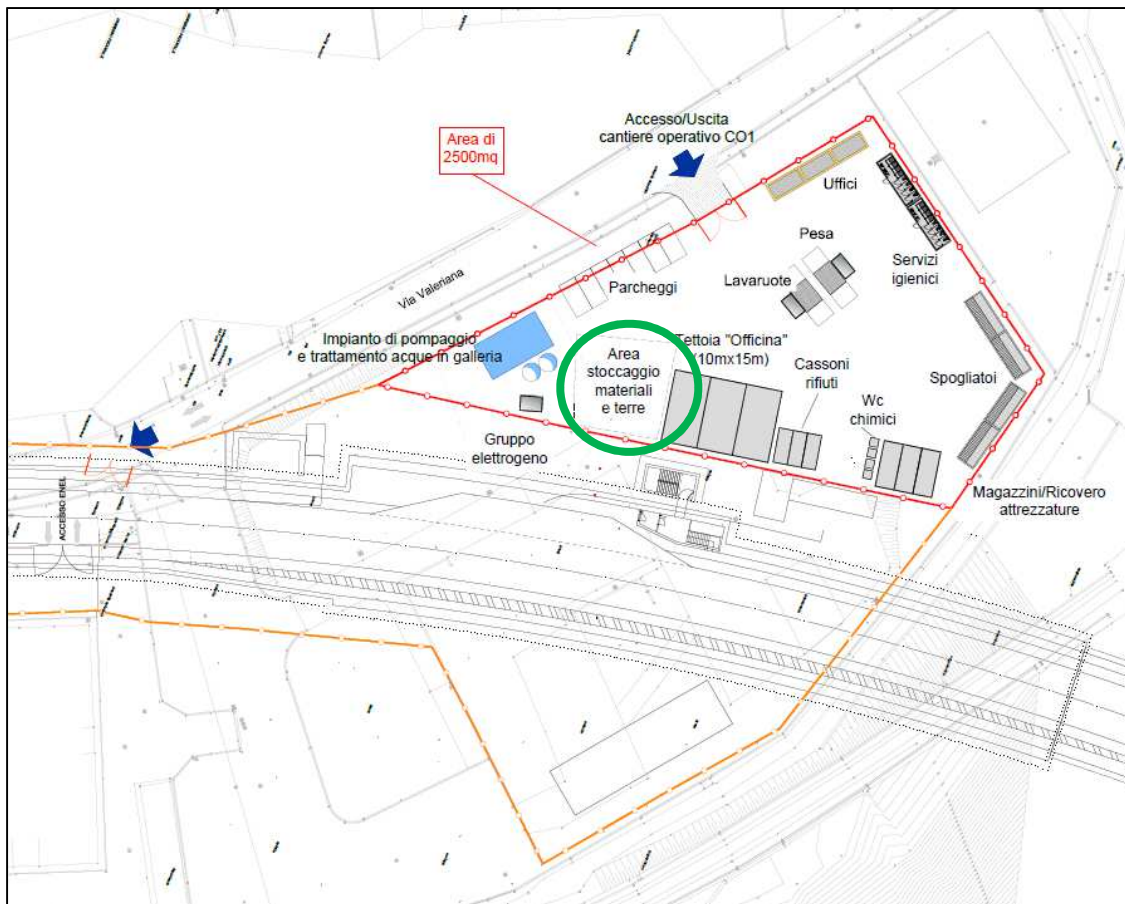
Area di Cantiere Sud con indicata in colore verde l'eventuale area di stoccaggio temporaneo (Immagine ricavata dal Doc.V02CA00CANSC01)
